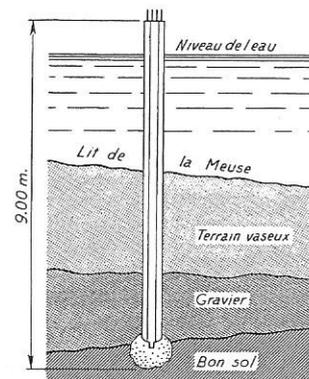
CROQUIS SCHÉMATIQUE D'UN PIEU FRANKI MIXTE (base élargie moulée dans le sol, surmontée d'un pieu en béton armé préfabriqué).
